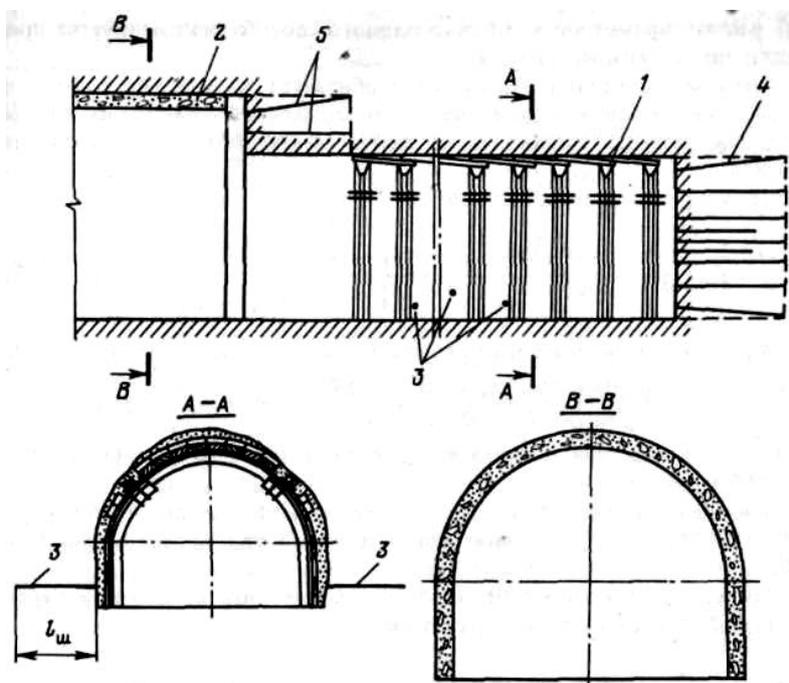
Схема проведения выработки в два этапа со взрывощелевой разгрузкой: 1 - крепь передовой выработки; 2 - крепь выработки проектных размеров; 3 - разгрузочные шпуры; 4 - шпуры по забою; 5 - шпуры по расширению передовой выработки от уже закрепленной части выработки для возможности ее передвижки с целью повторного использования
